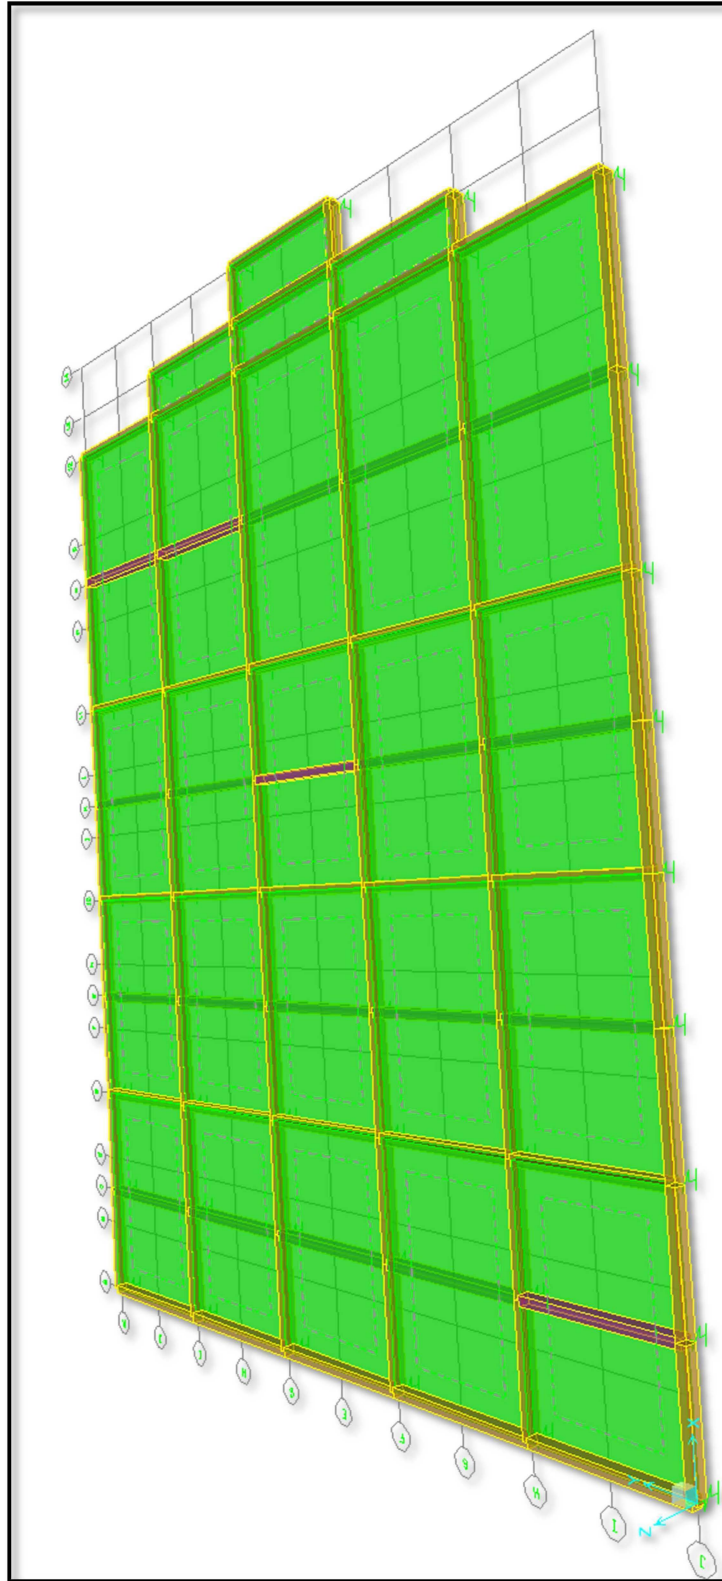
8 Vista extruida de la losa de cimentación con sus respectivas contratrabes
